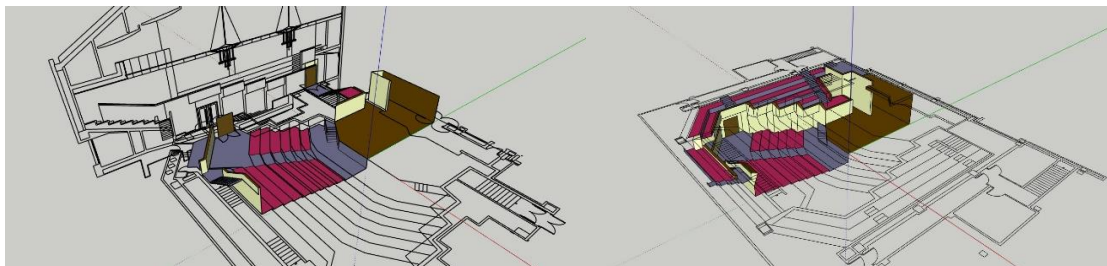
Modelo en tres dimensiones de la Planta baja y escenario, tribuna, anfiteatro lateral de la primera planta
